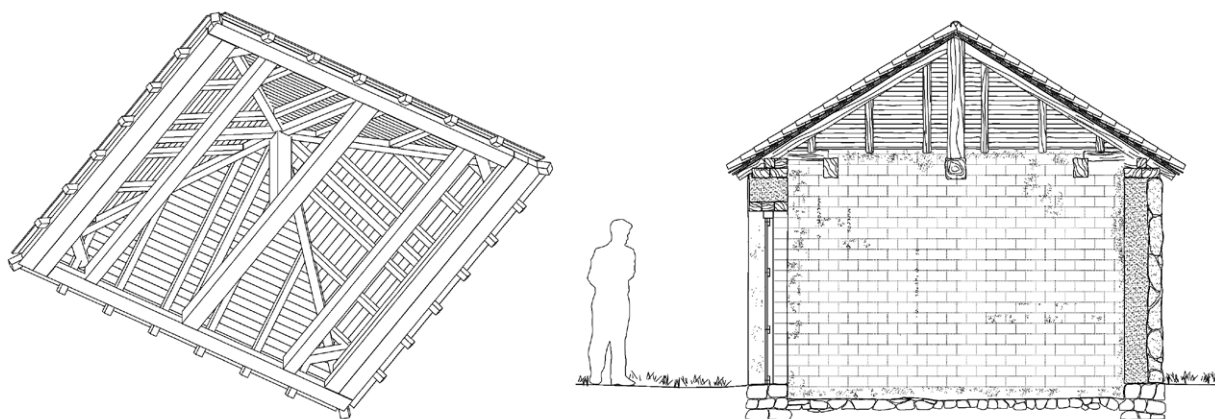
Dibujo tridimensional de la estructura de la cubierta desde una perspectiva del interior de la caseta y sección de la construcción. Fuente: autor
